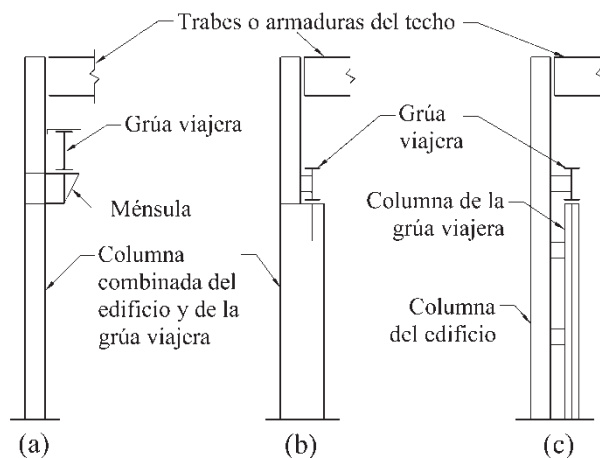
Distintos tipos de columnas con grúas viajeras
